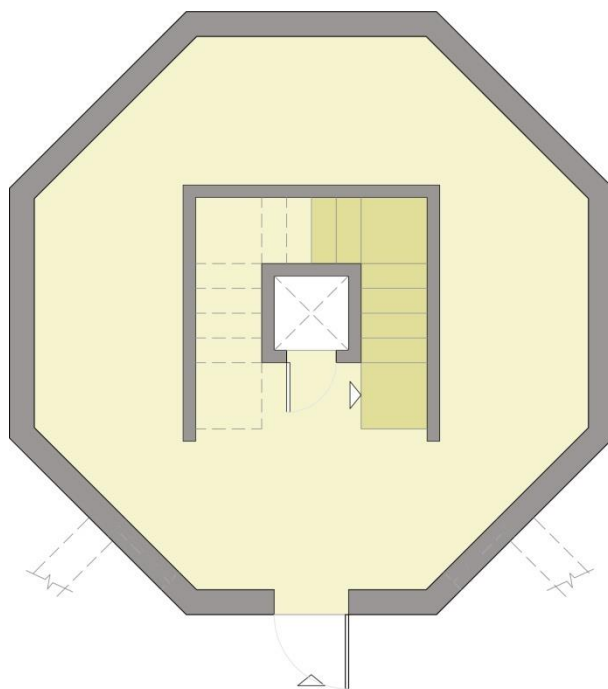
Planta baixa do Posto de Controle P1 – Pavimento Vigilância
